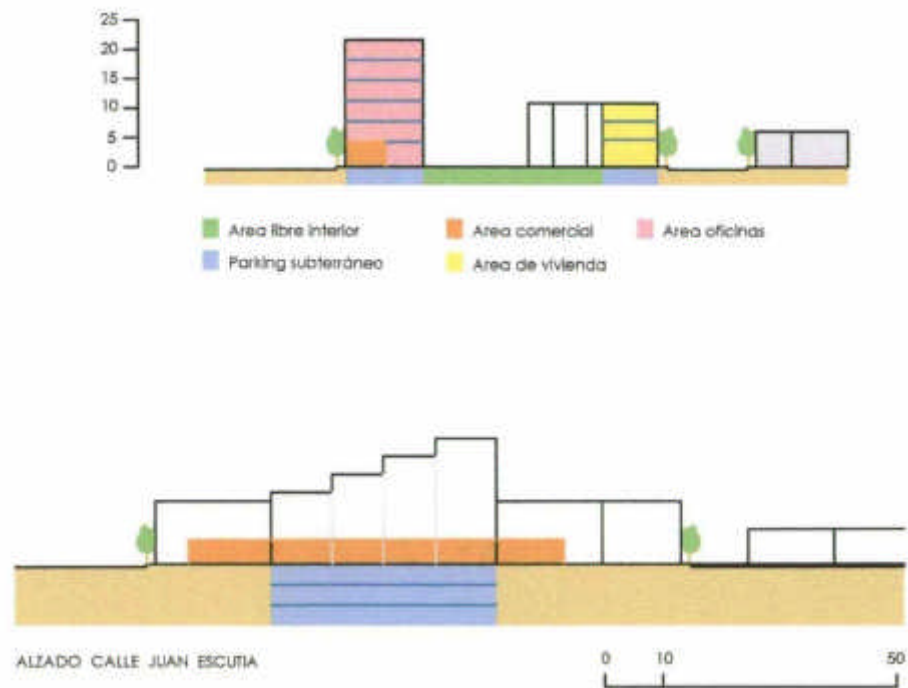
ALZADOS DE LA PROPUESTA DESARROLLADA EN LA MANZANA TRIANGULAR.
